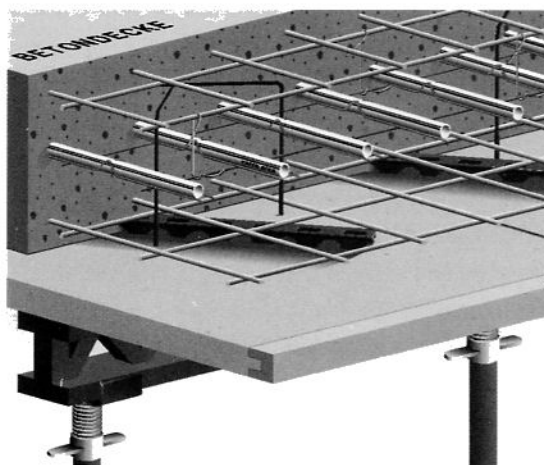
Coupe d'un plafond en béton pour chauffage et refroidissement
